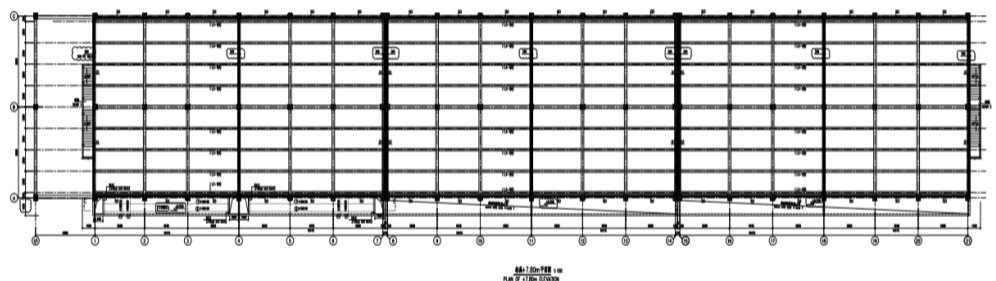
Planta do nível 7,80 m da torre de arrefecimento da CCC do Soyo.
